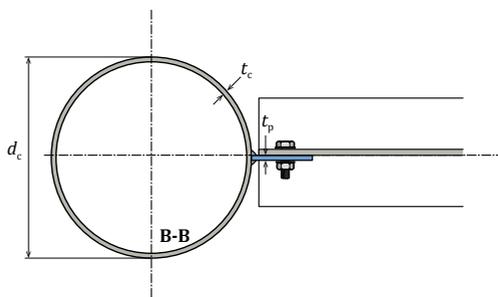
Assemblage articulé par gousset sur poteau à section creuse circulaire
